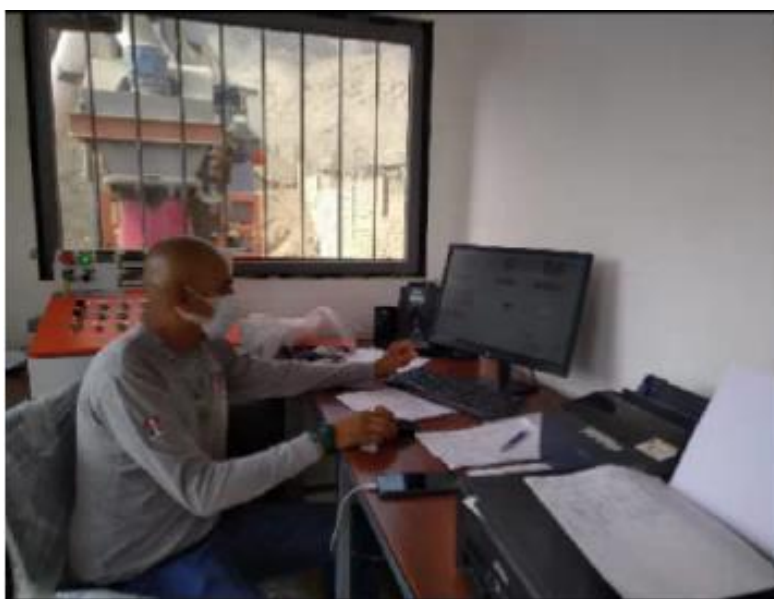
Automatizacion de planta dosificadora de concreto Construcmix 2020. Fuente : Elaboracion propia (2020)
